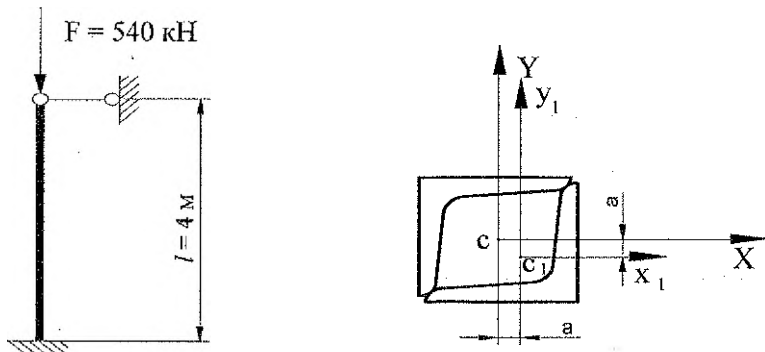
Расчетная схема стойки и ее поперечное сечение
